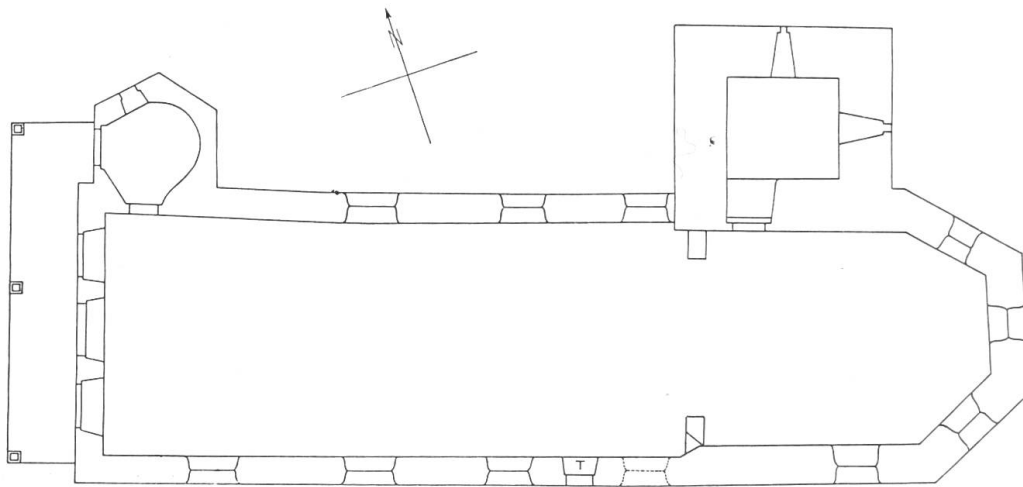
Rekonstruktion der Kirche nach der Erweiterung von 1668/69. Grundriss.
